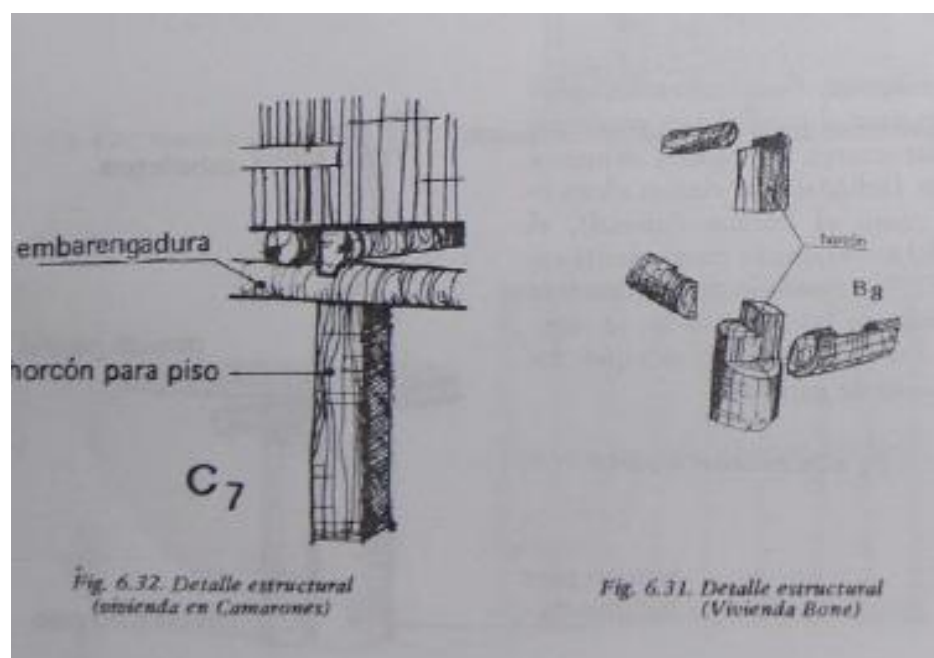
Ensamblado y corte para la estructura del piso de pambil.
